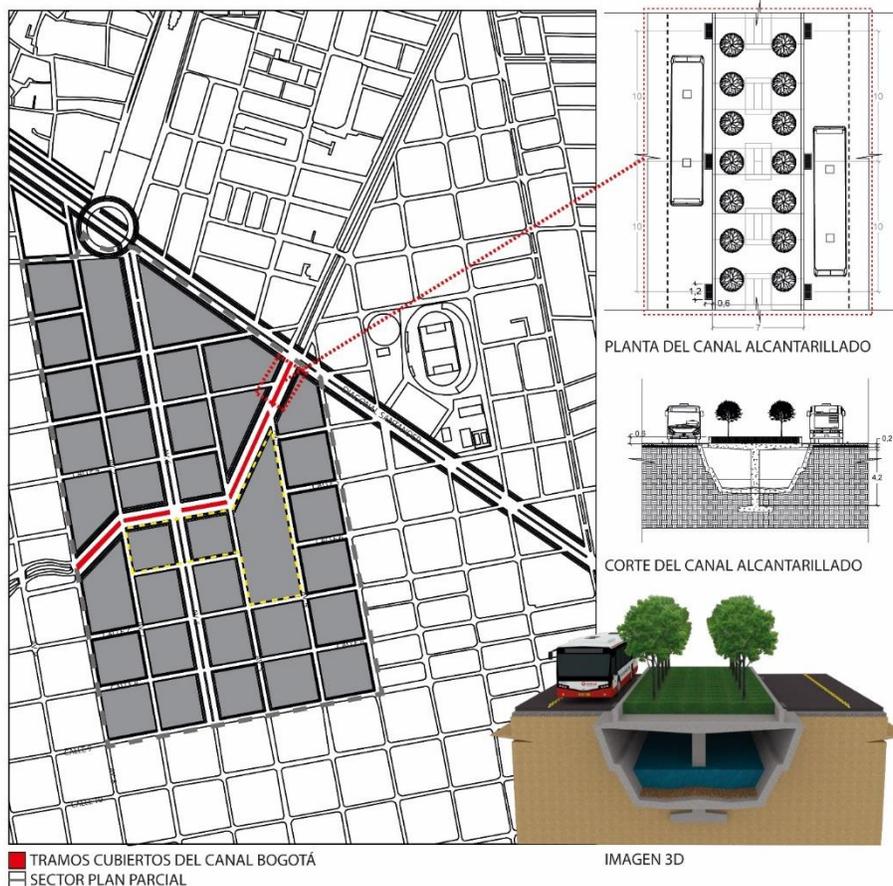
Detalle de alcantarillado propuesto para el canal Bogotá". Fuente: Elaboración propia.
